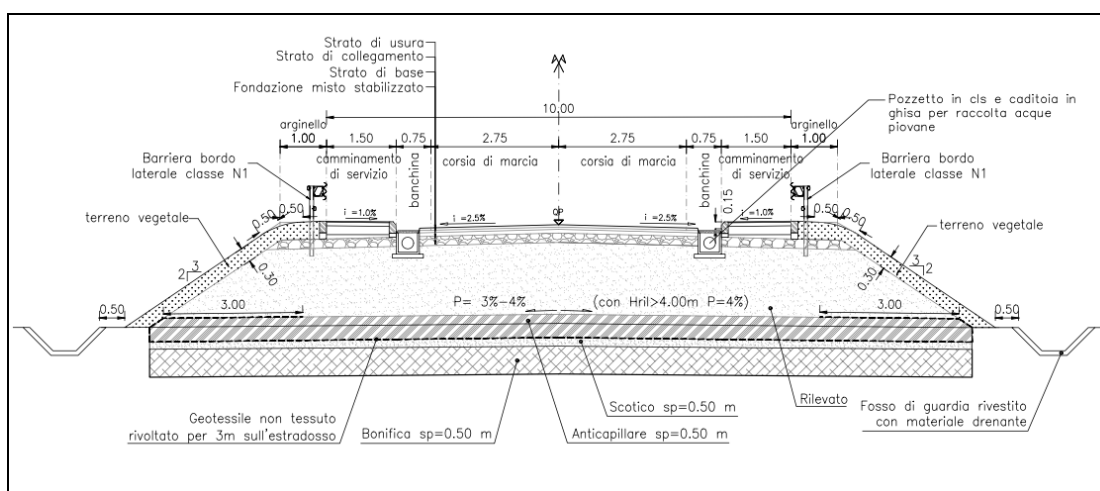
Sezione tipo in rilevato in prossimità dell'intersezione con via Argine Sinistro.
